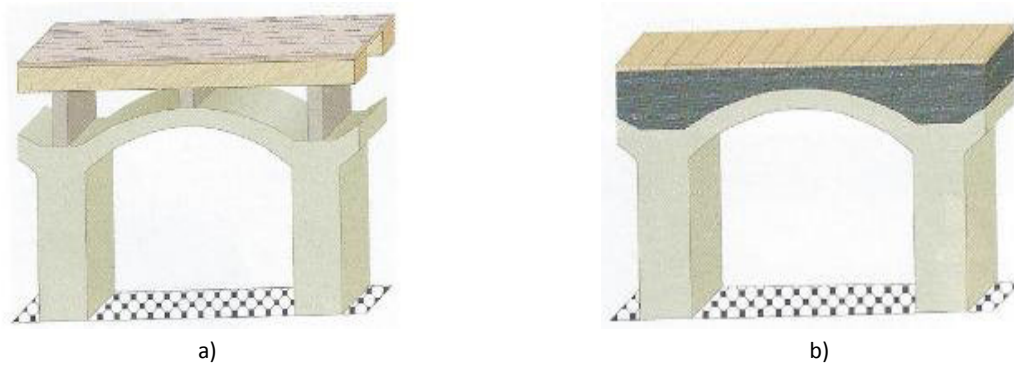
Corte esquemático de arcos[4]: a) Estrutura de madeira; b) Enchimento das abóbadas.
